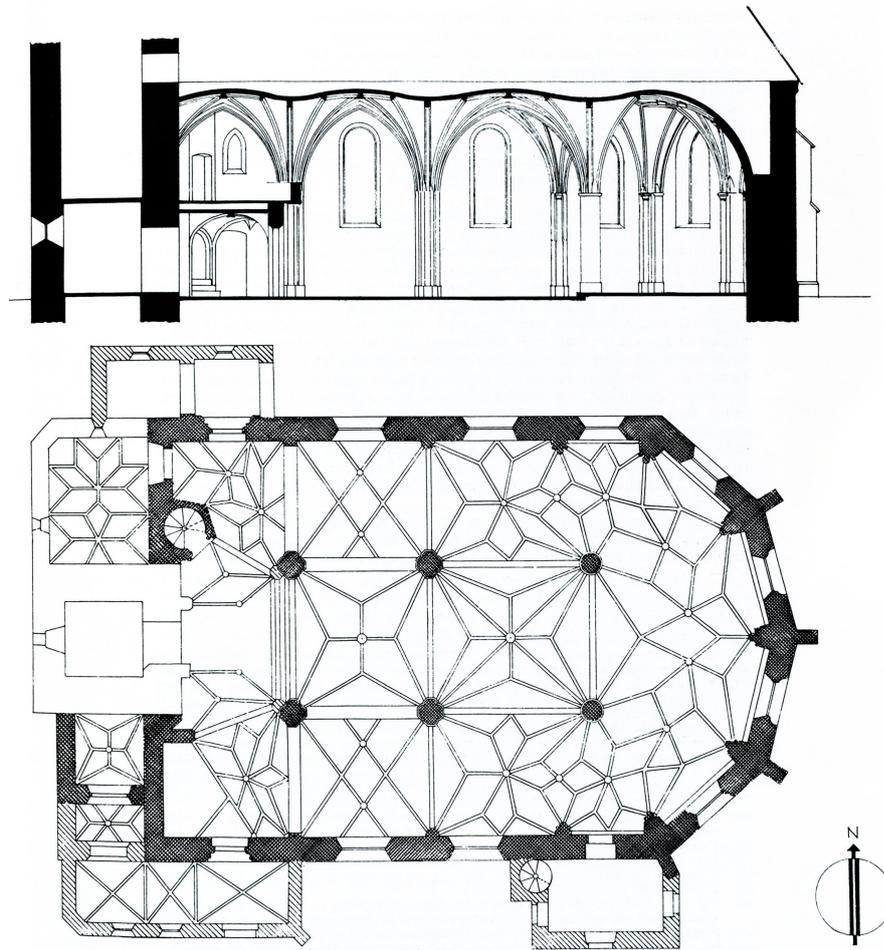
Pischelsdorf, Pfarrkirche. Grundriss und Längsschnitt. Bild: Nussbaum 1984, S. 103.
